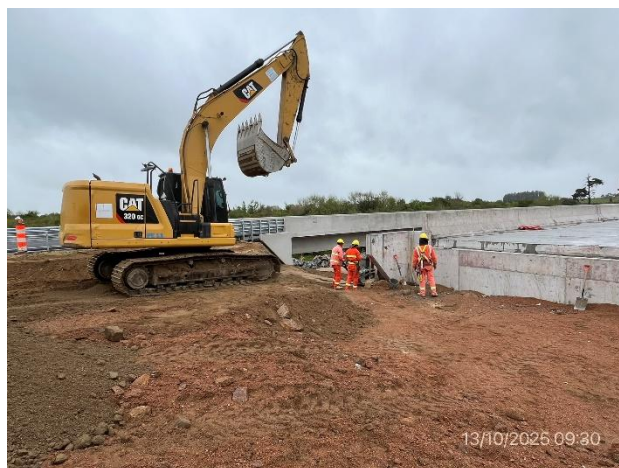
, P02. Terraplenes de acceso al puente de senda a (-) en construcción.
